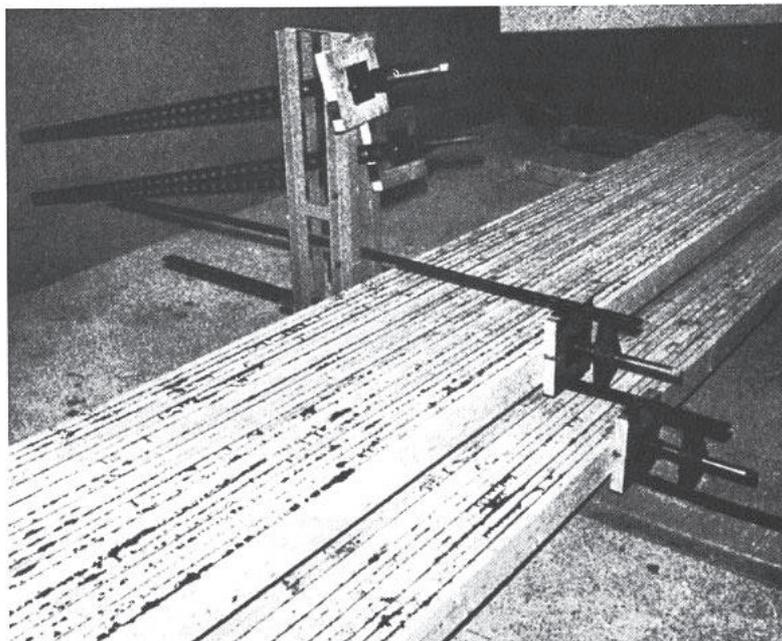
Prensagem de lâminas de madeira com interposição de cola, para duas vigas retangulares de madeira laminada colada (Holzbau Taschembuch, 1974).
